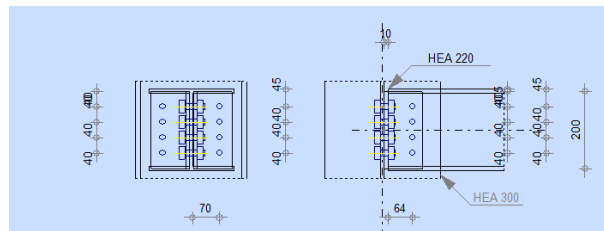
Assemblage poteau-poutre secondaire
